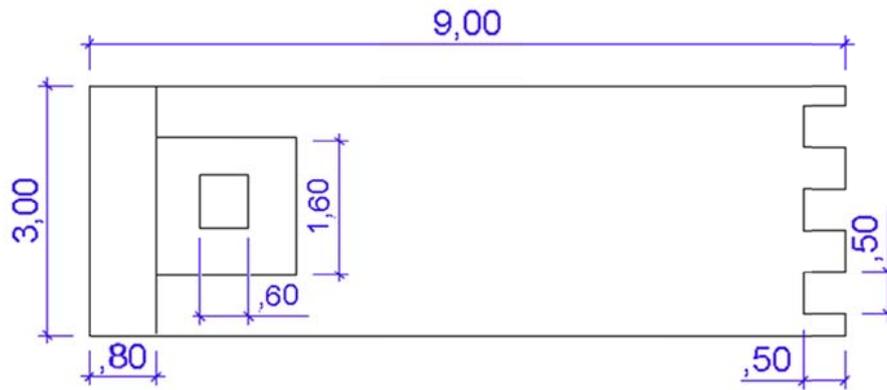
Esquemático do Tanque de Decantação Conceitual (em planta).
